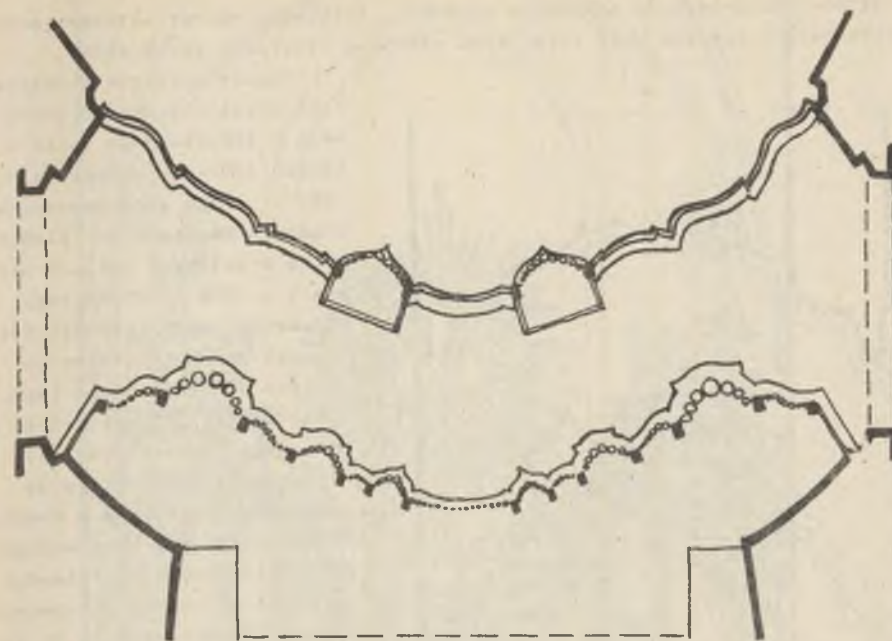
Plan prospektu organów M. Englera w kościele św. Mikołaja w Brzegu
